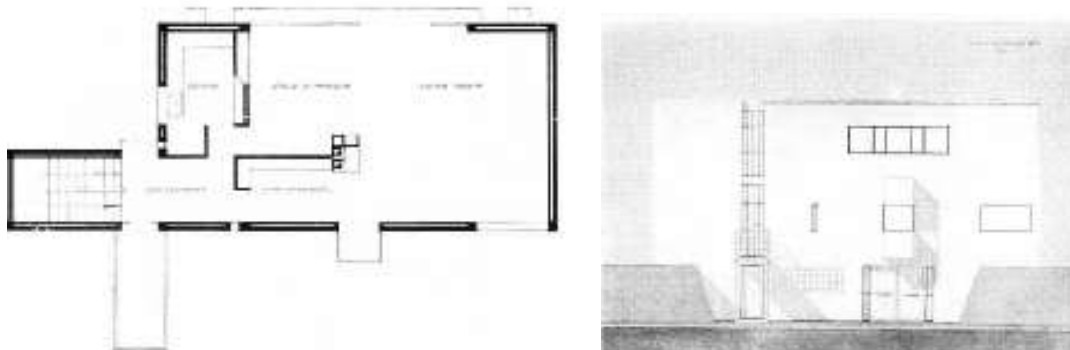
e 11. Planta e fachada da Villa em Vaucresson, 1922
